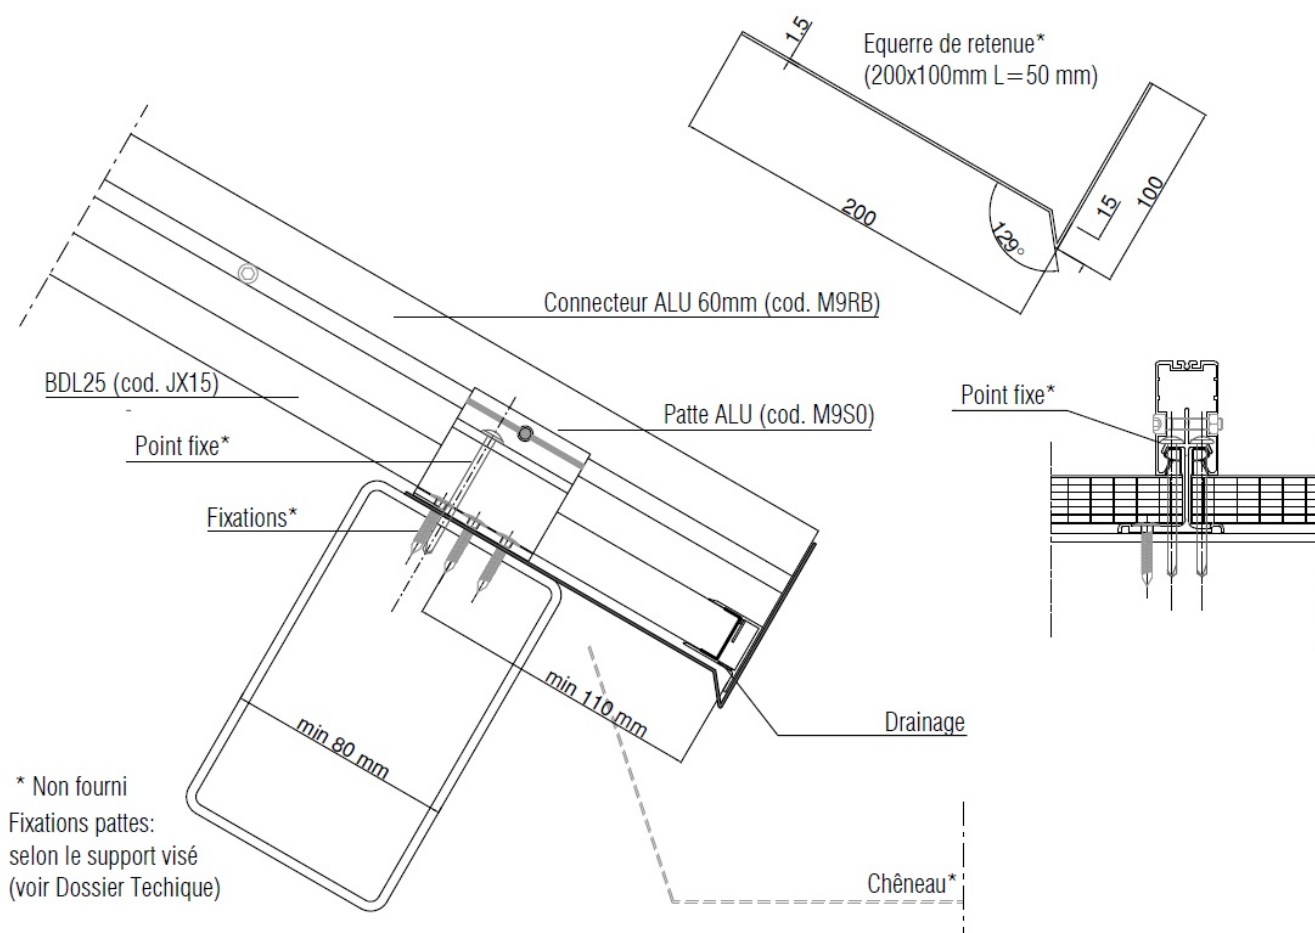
Egout avec point fixe bas et connecteur M9RB
